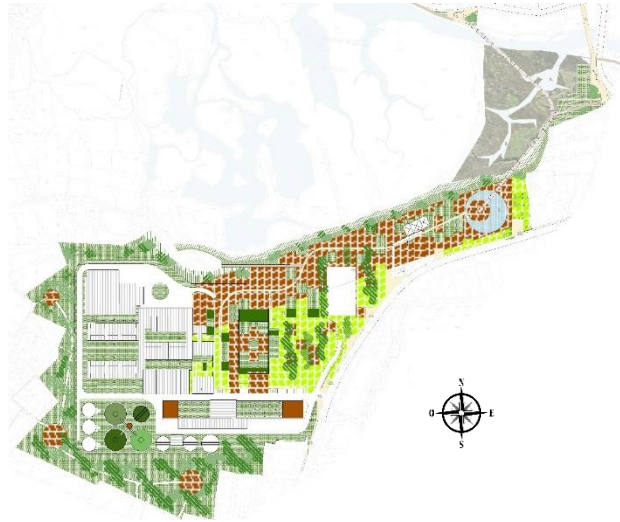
Vista en planta de EDAR [Fuente: STS]
